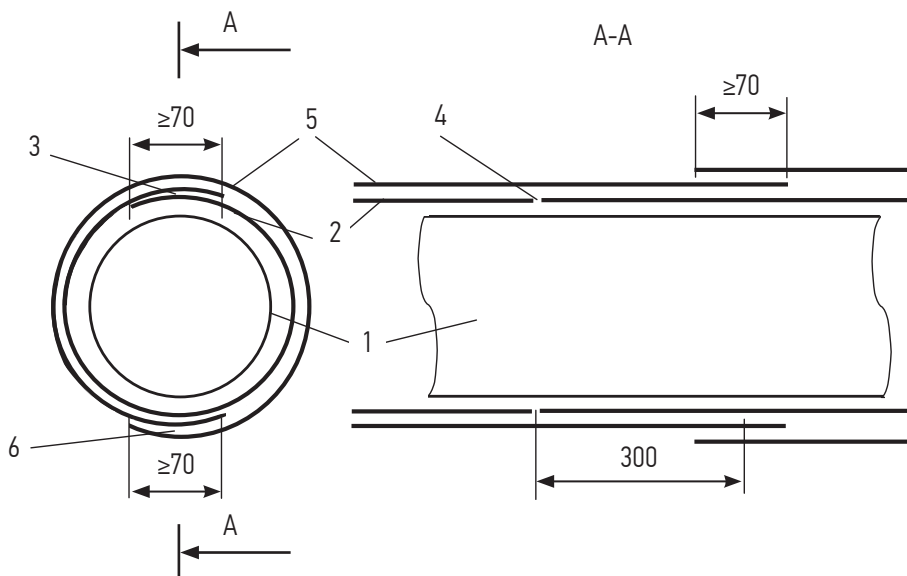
Нанесение покрытия РПВ-2 на воздуховод двумя слоями
